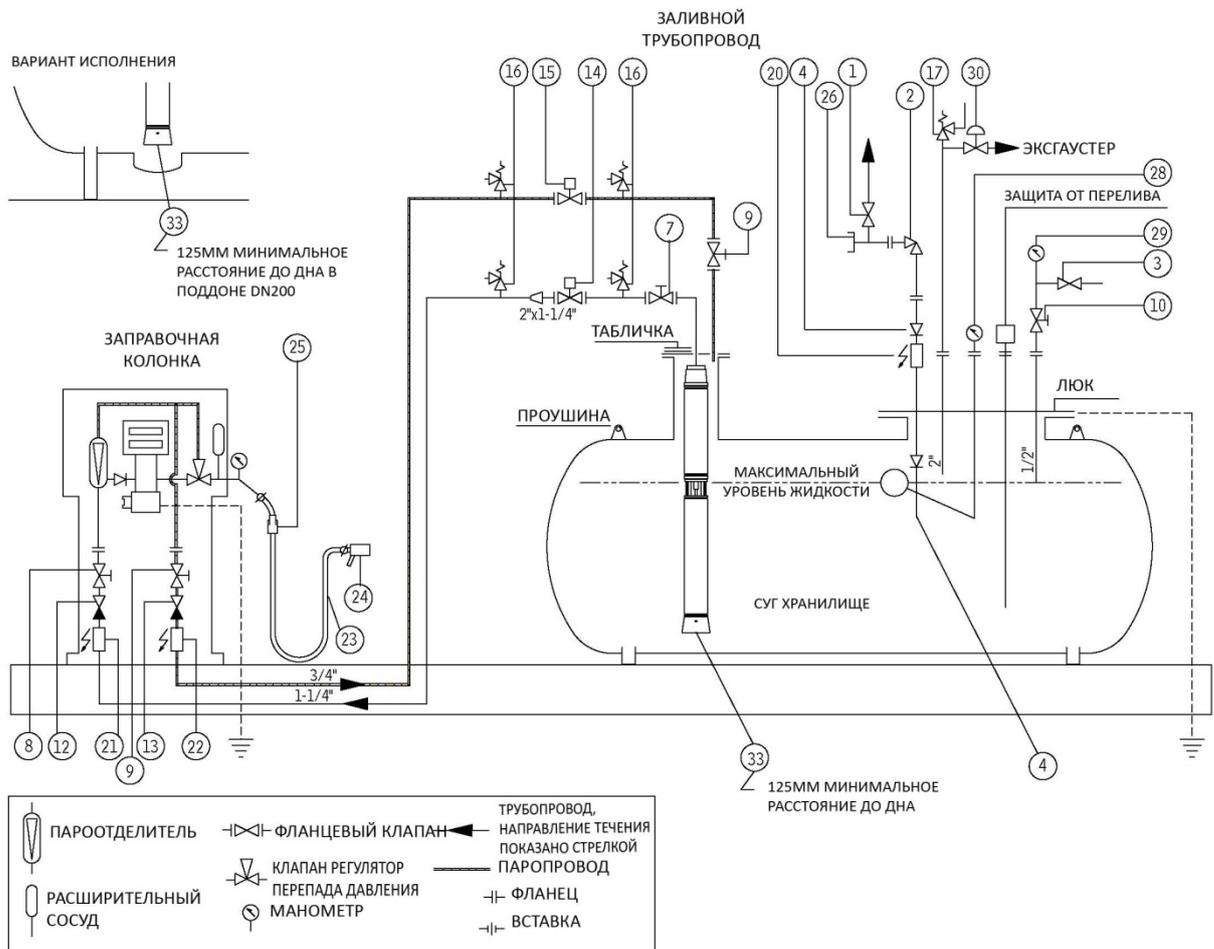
Типовая схема для прямой установки с вертикальным расположением сборки насос-двигатель
